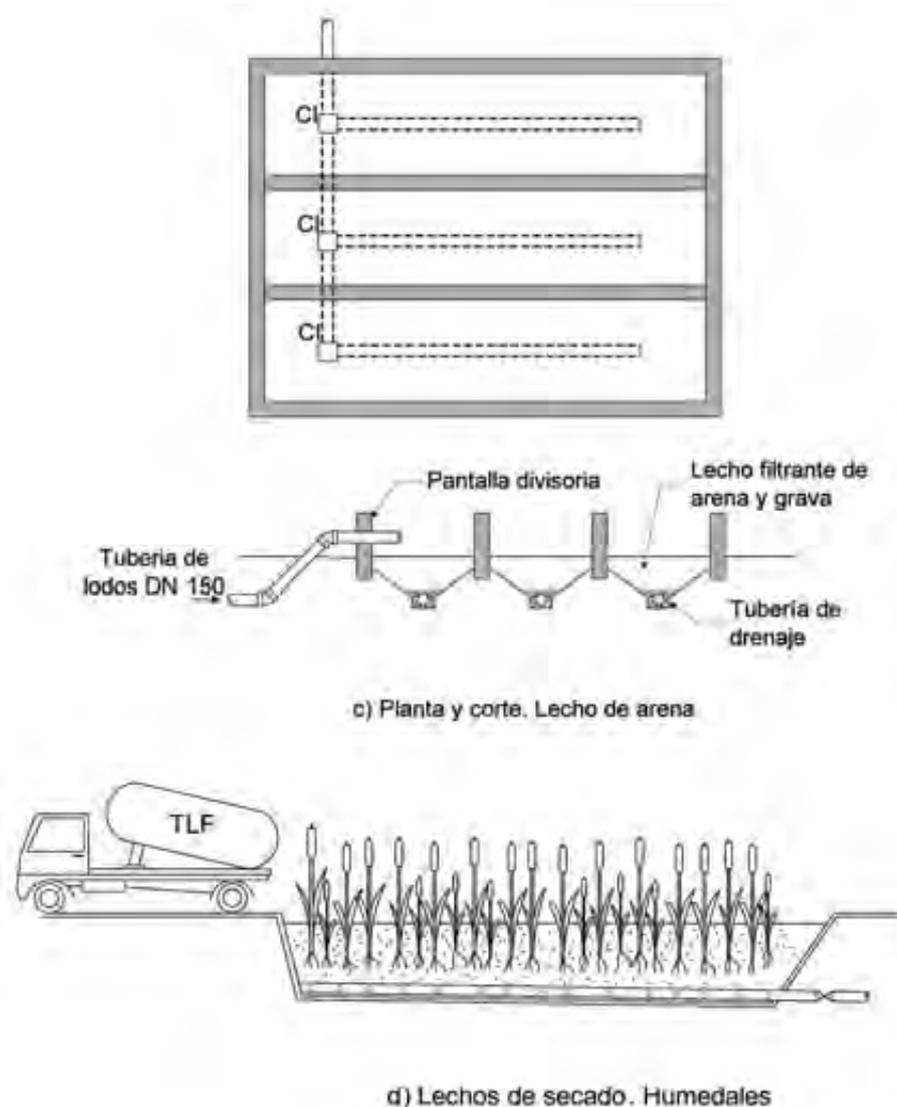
Detalles constructivos. Lechos de secado de lodos
